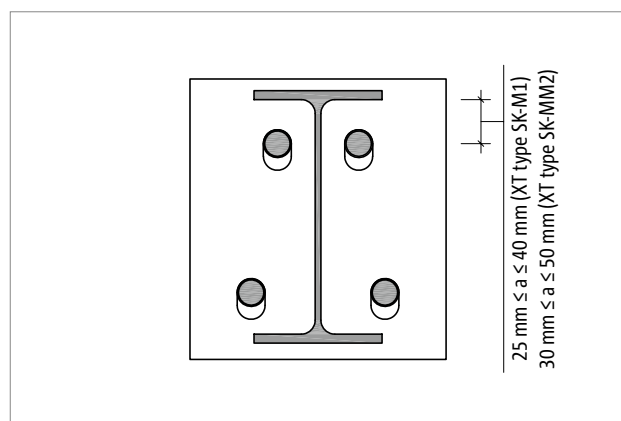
Schöck Isokorb® XT type SK-MM2 : raccordement de la platine frontale sur la poutre IPE220 avec Isokorb® hauteur H200
